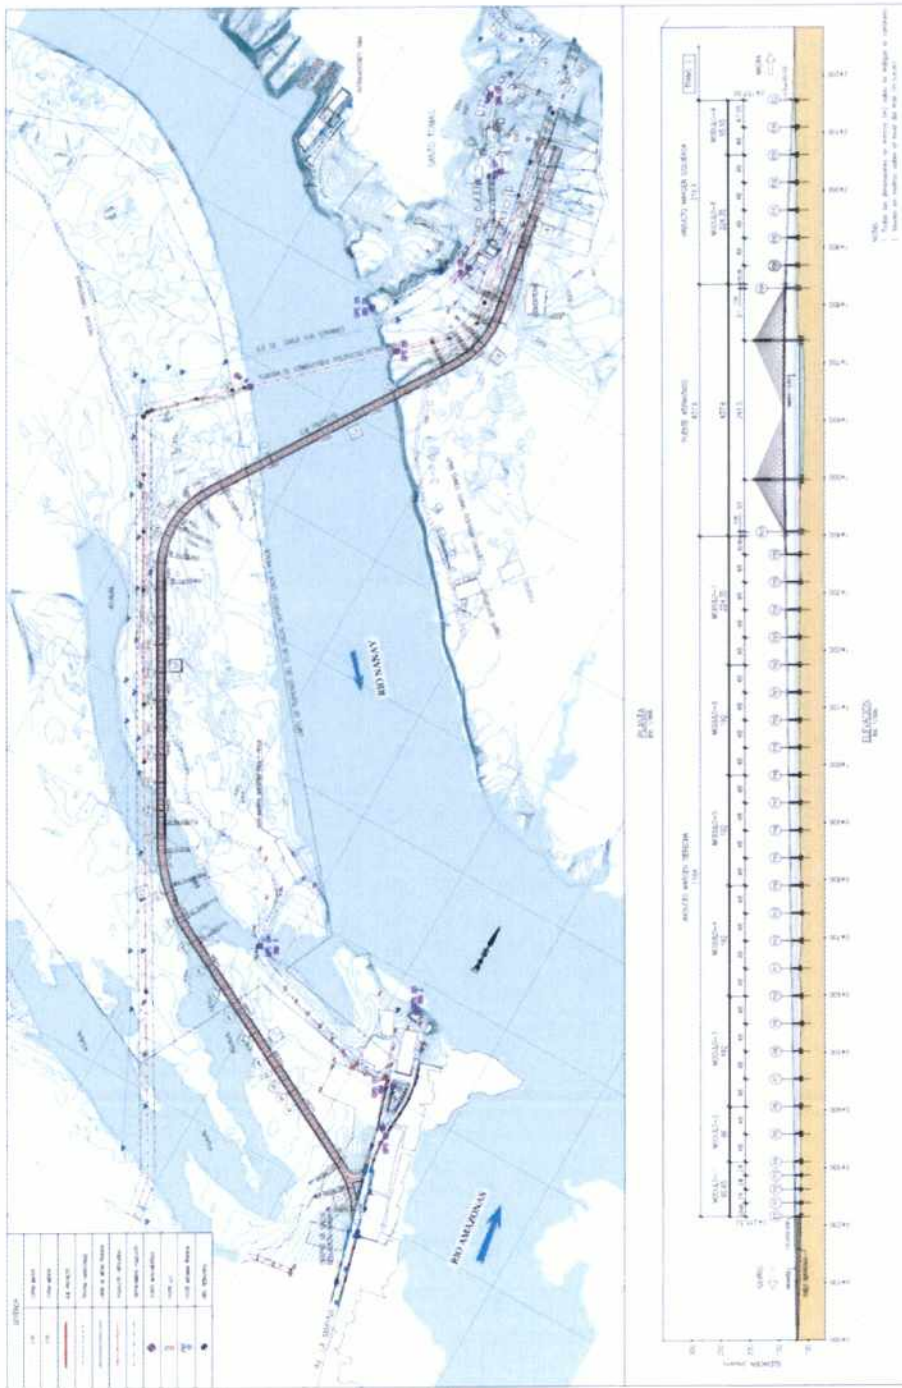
Planta y Elevación del Puente NANAY y Viaductos de Acceso
